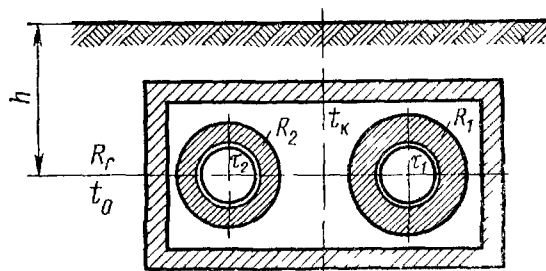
Расчетная схема двухтрубного теплопровода канальной прокладки
